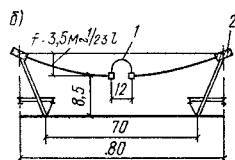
Однопропные покрытия с гибкими вантами и железобетонными плитами
